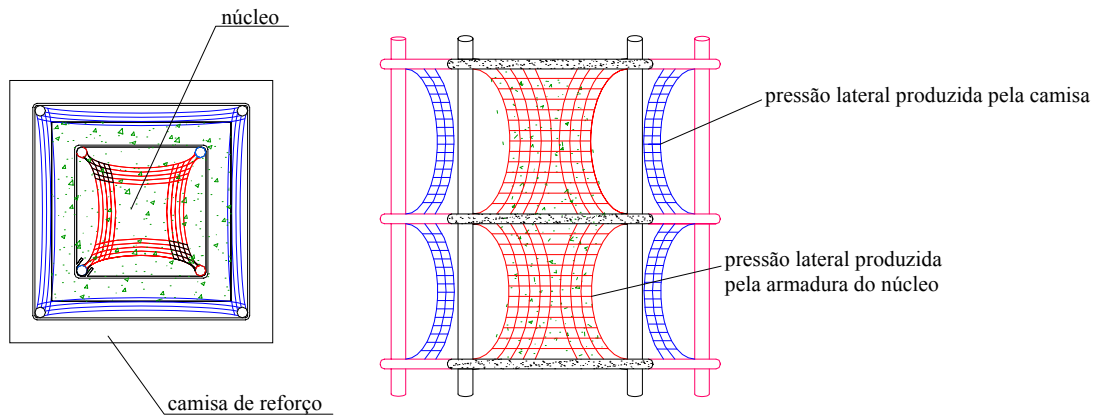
Pressões laterais idealizadas para pilares reforçados
